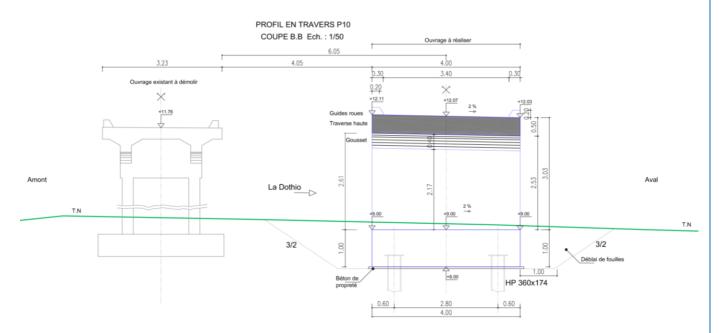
vue du profil en travers sur l'ouvrage (source: DEPS, 2018).
